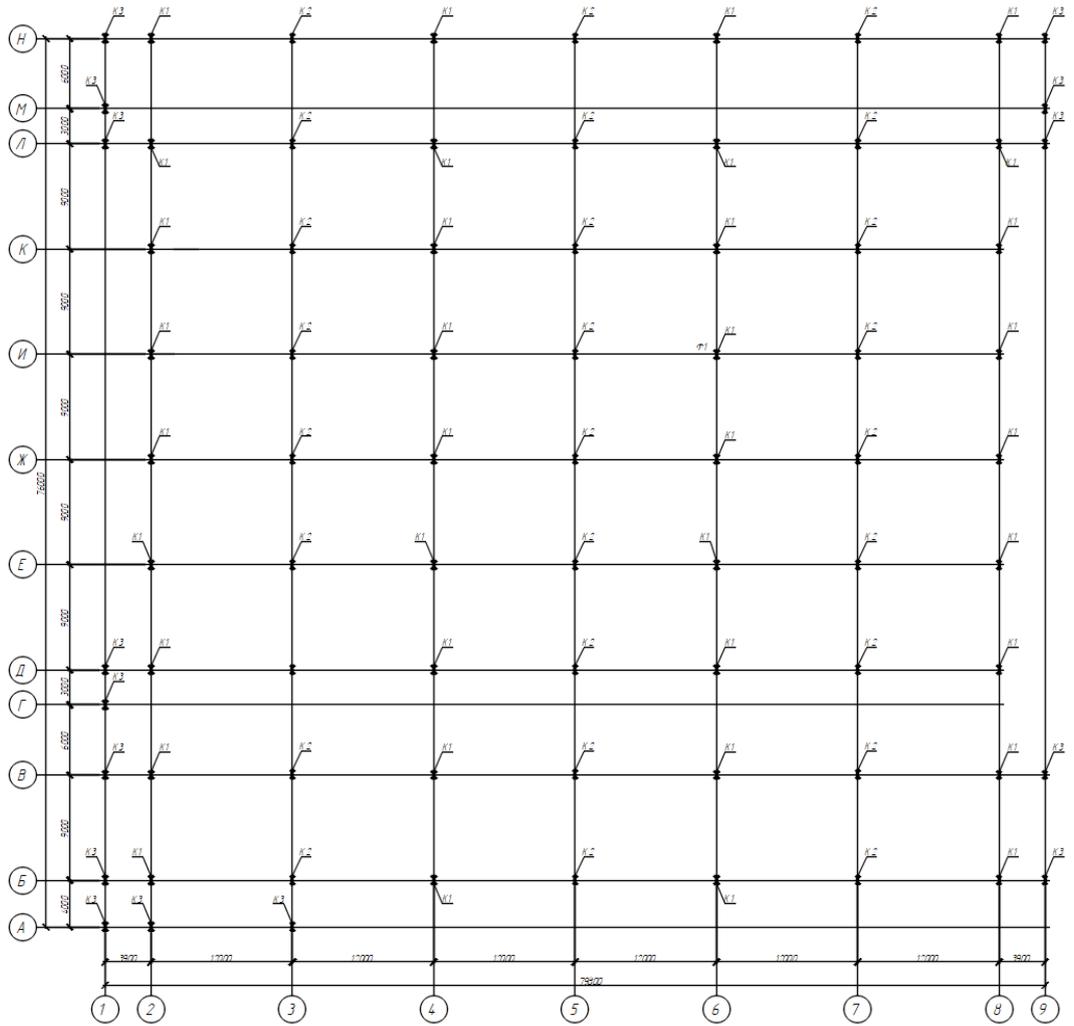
Схема расположения колонн, балок перекрытия, ферм
